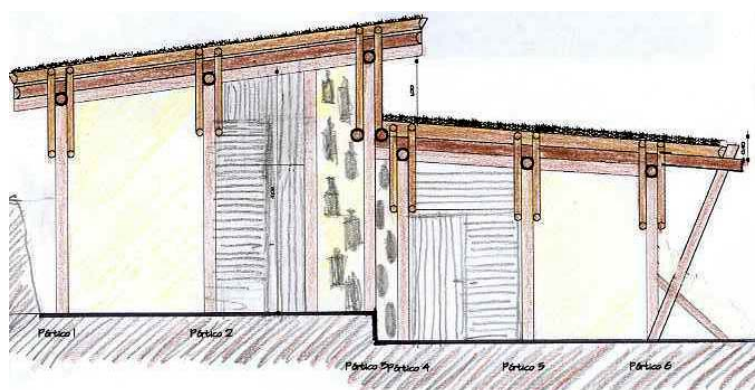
croqui da estrutura da edificação <sup>16</sup>
